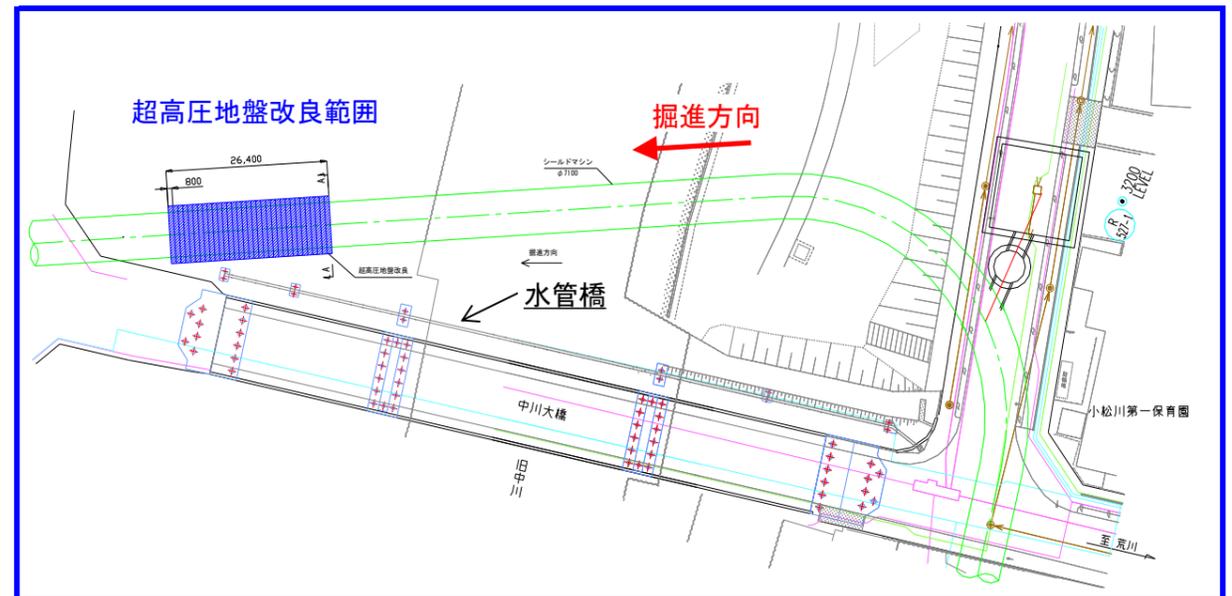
DO-Jet施工箇所平面図(水管橋防護改良)
